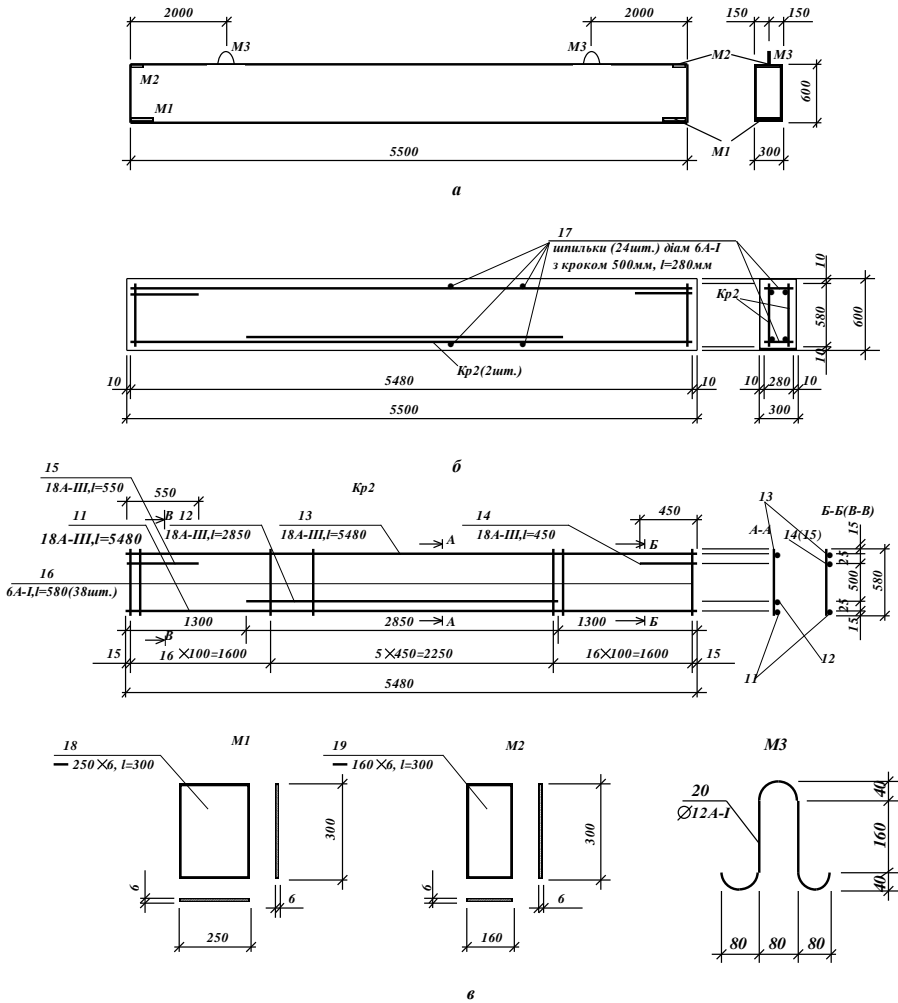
Ригель P2: *а* – опалубне креслення; *б* – армування ригеля зварними каркасами; *в* – арматурні вироби
